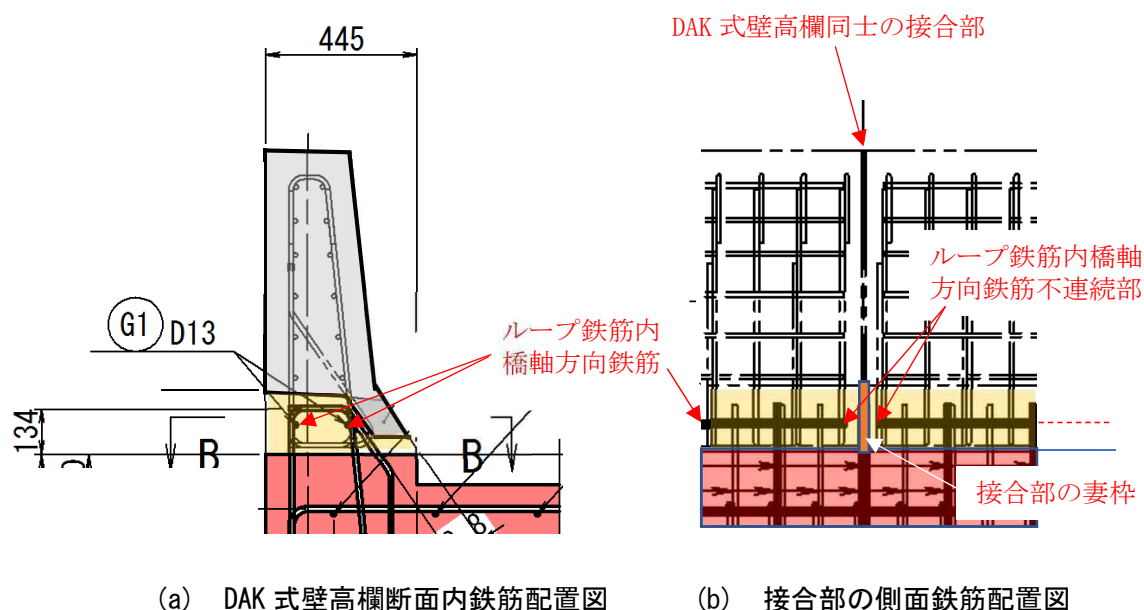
接合部のループ鉄筋継手内に配置される橋軸方向鉄筋の不連続配置図
